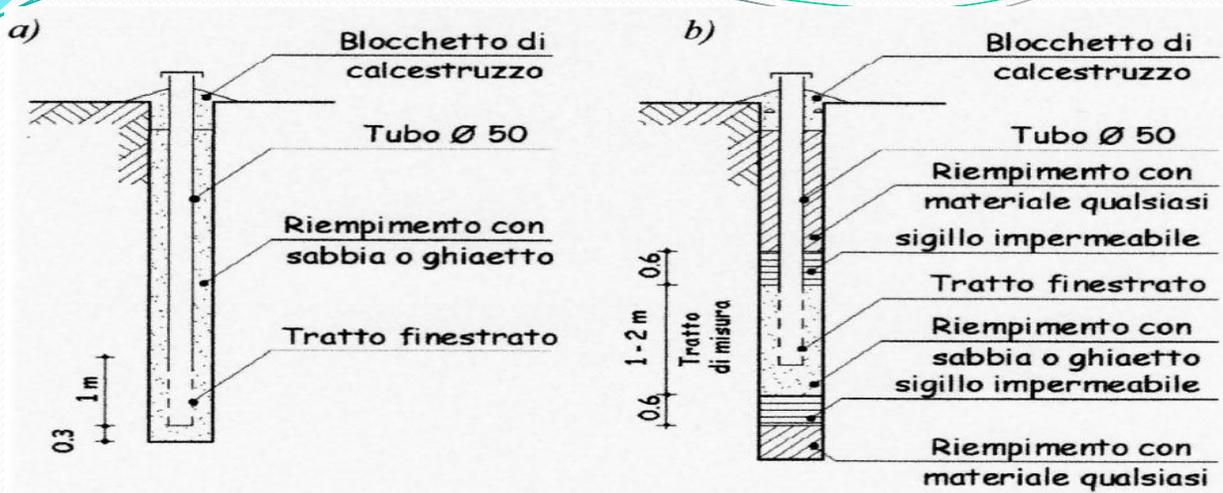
a) pozzo di osservazione; b) piezometro aperto a tubo fisso
